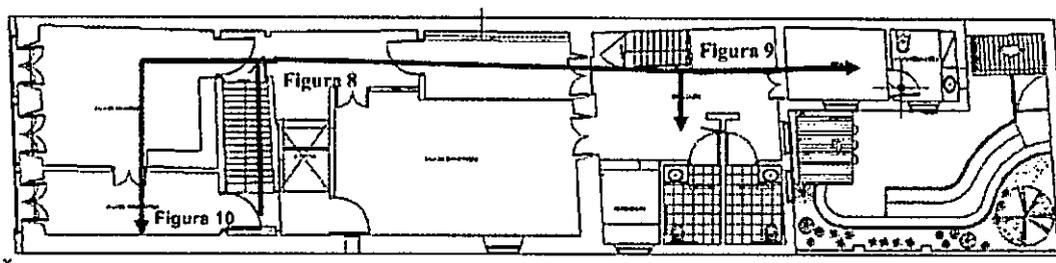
Mapa da rota 2 – Do pavimento térreo ao pavimento superior.
